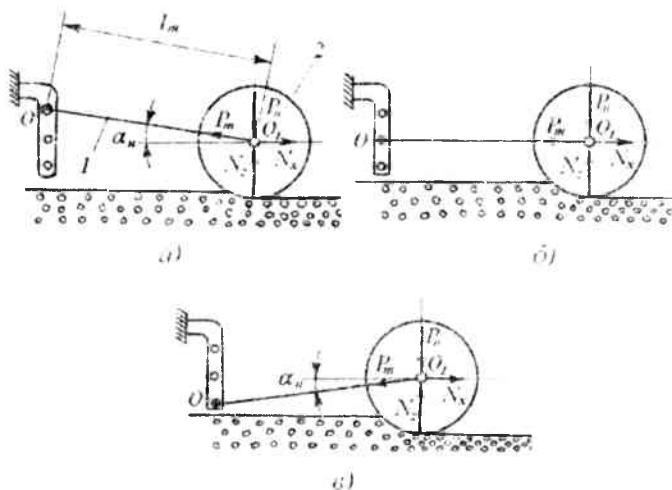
Схемы расположения тяговой штанги относительно горизонта: 1 – тяговая штанга; 2 – каток
